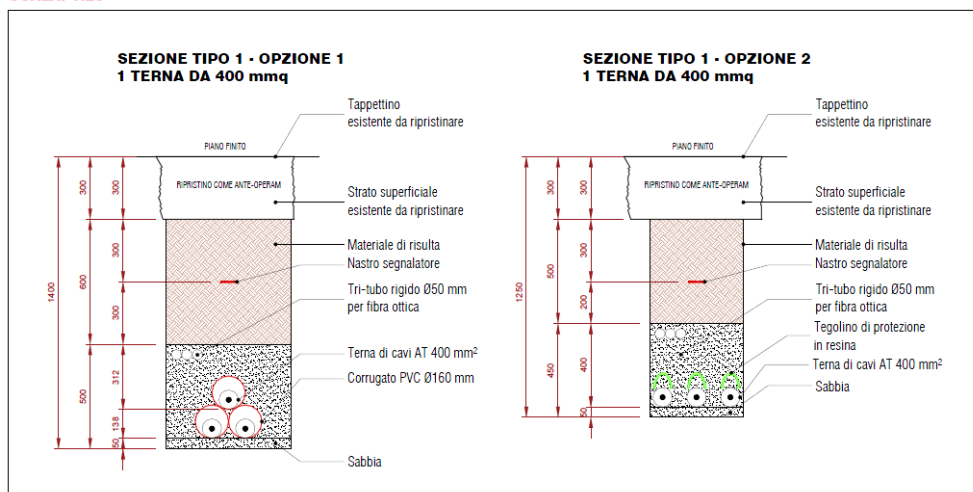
Sezioni tipo di scavo per cavidotto collegamento SSE utente – SE Terna
